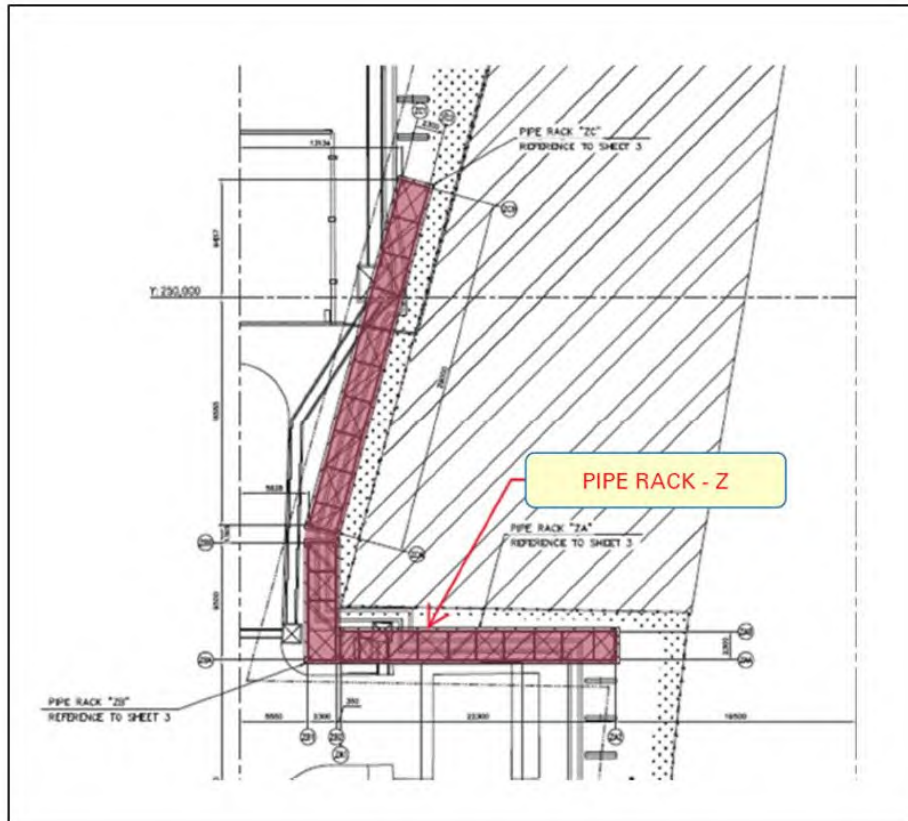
โครงสร้างฐานคอนกรีตเสริมเหล็กสำหรับติดตั้ง Pipe Rack (Pipe Rack Foundation) จำนวน 6 ตำแหน่ง
